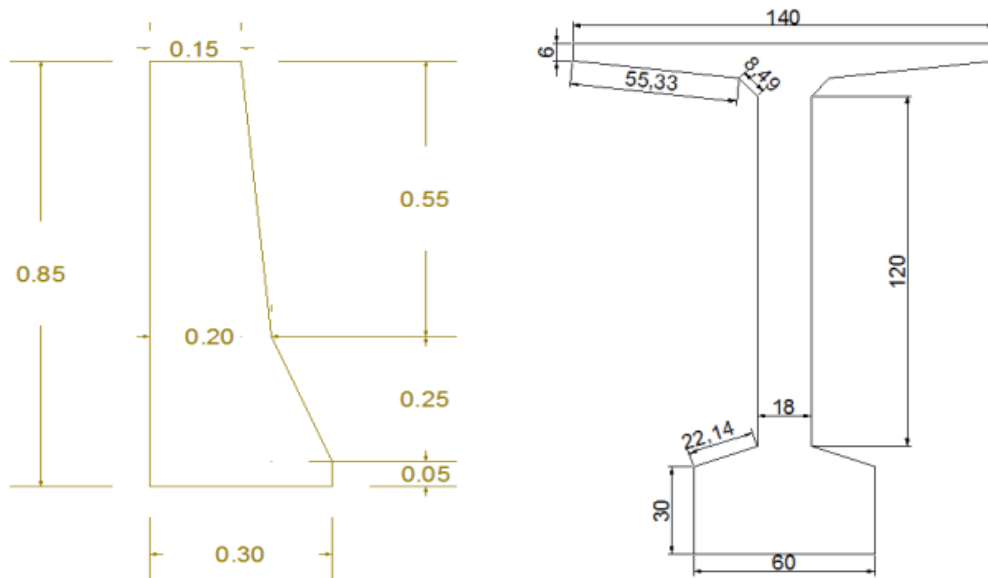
SECCION DE LA DEFENSA Y VIGA
